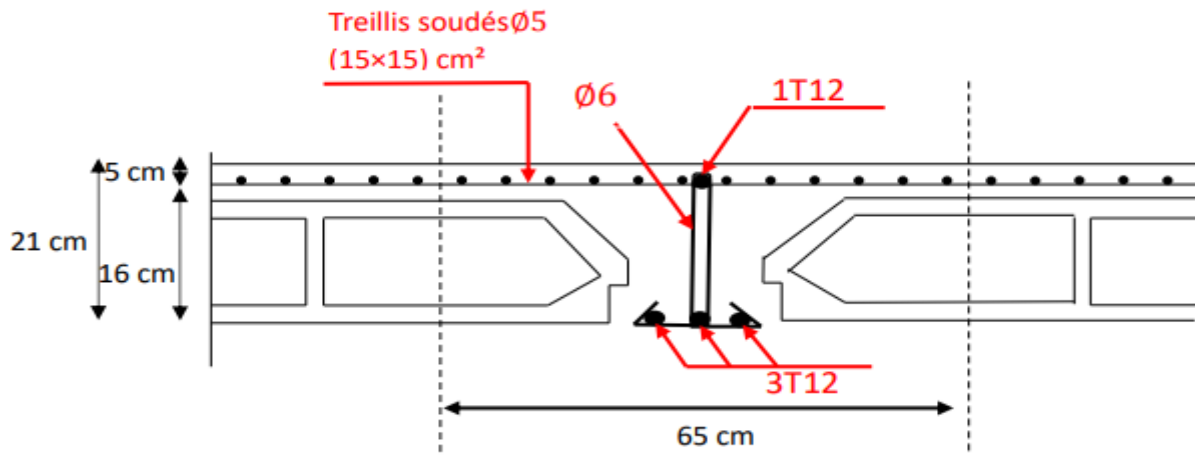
Schéma des ferrailages des poutrelles en travée
